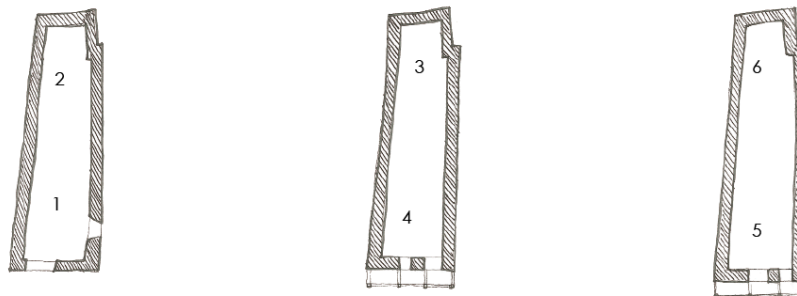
Planta baja, planta primera y planta segunda del caso de estudio 8 – Tipología 1
